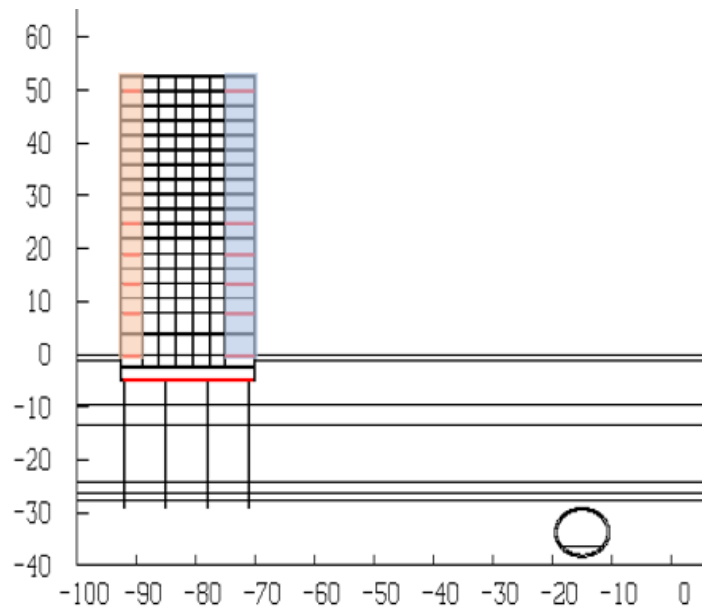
Bâtiment de gauche : 4 murs de 18 cm pour 22,8 m (taux : 3.16%)
